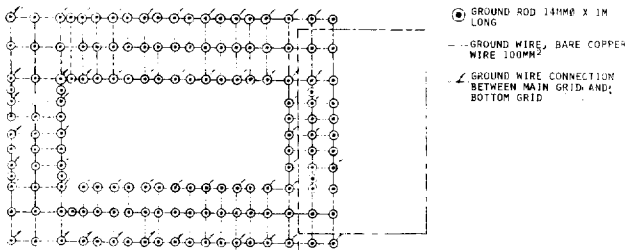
EHV LAB. Grounding Layout (EL-7,000)
